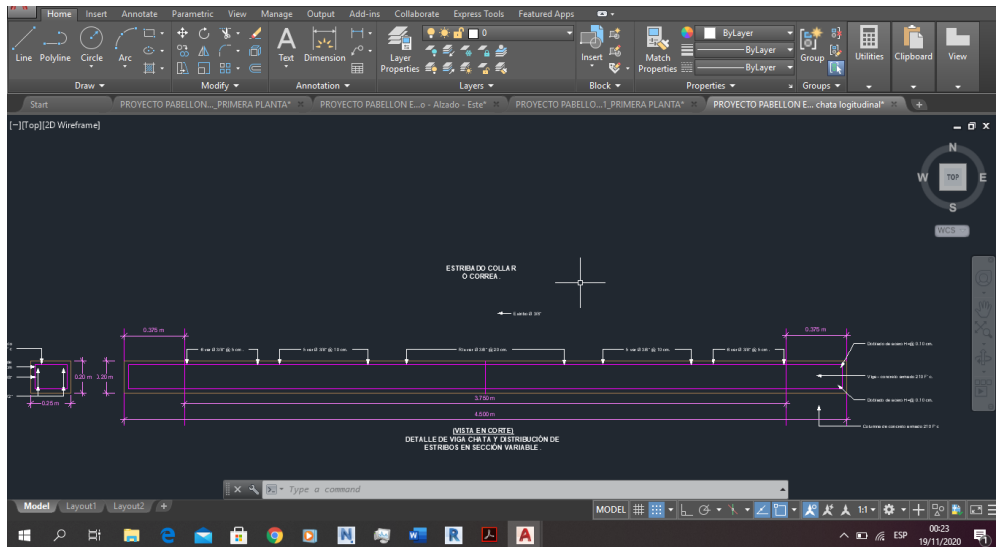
Vista en corte de elementos estructurales de la edificación con AutoCAD
